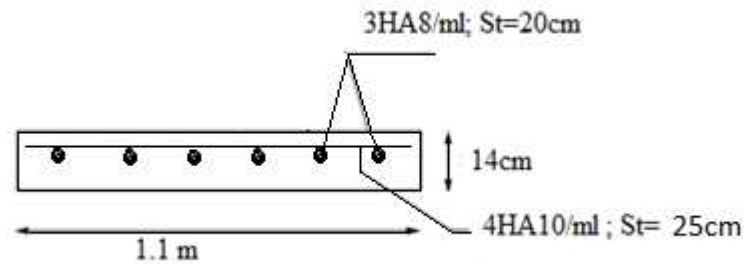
Schéma de ferrailage de la dalle pleine type 1
